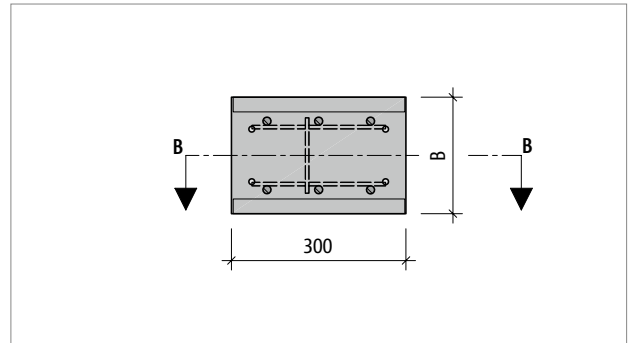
Schöck Sconnex® Typ W-T2: Produktgrundriss
